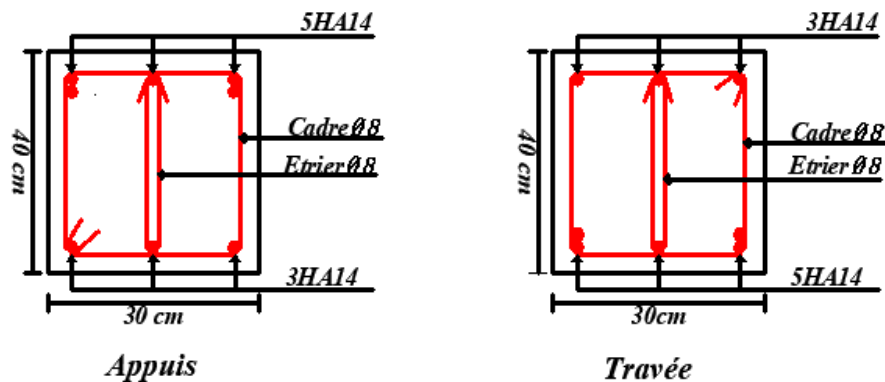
Schéma de ferrailage de la poutre secondaire de différents planchers
